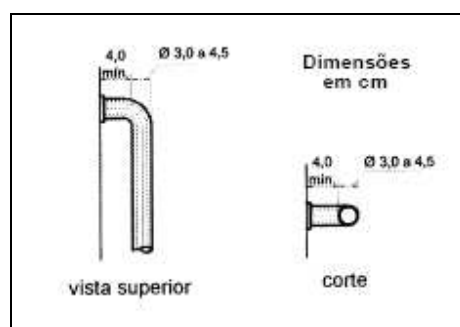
Barras de apoio (Figura 113 da NBR 9050).
